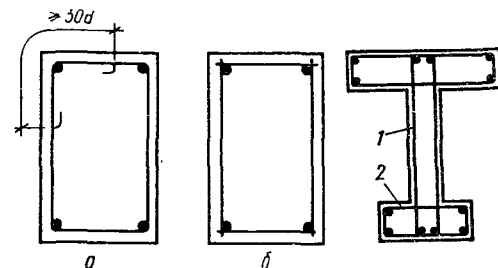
Армирование балок, работающих на изгиб с кручением вязанной арматурой (а) и сварным каркасом (б).
